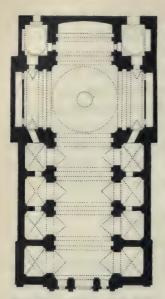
Tolebo. San Juan Bautista. Grundriß.
